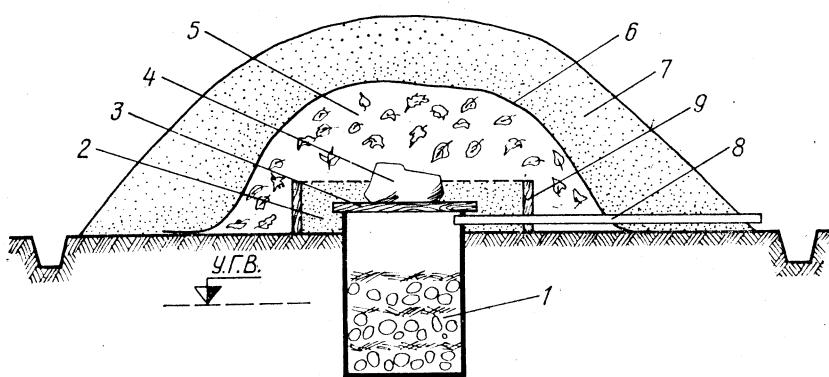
Хранилище из полиэтиленовой бочки: 1 — полиэтиленовая бочка; 2 — опилки; 3 — деревянная крышка; 4 — пригруз; 5 — сухой лист; 6 — полиэтиленовая пленка; 7 — обваловка; 8 — деревянный щиток; 9 — полиэтиленовая трубка диаметром 20 мм
